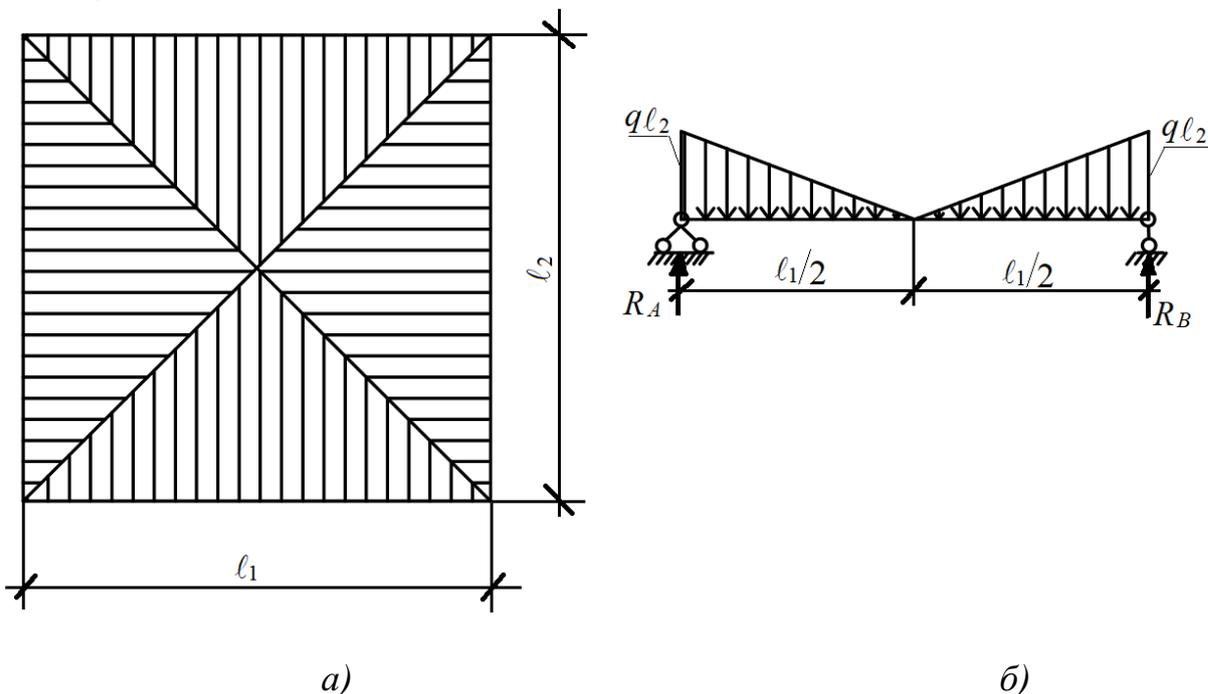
Схема розподілу навантаження: а – розподіл навантаження у двох перпендикулярних напрямках плити; б – розрахункова схема для статичного методу розрахунку
